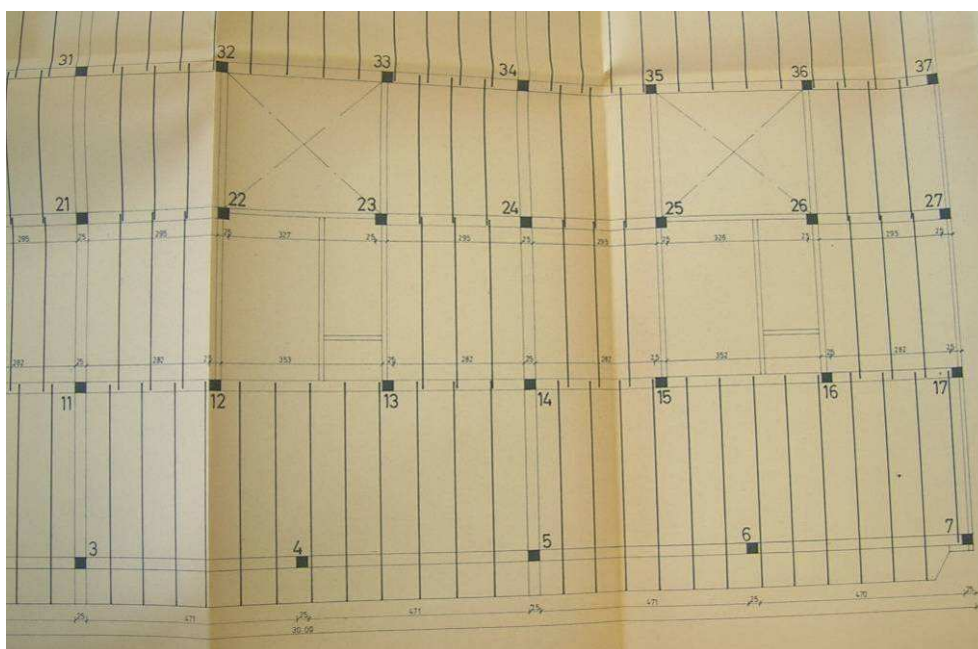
Planta de estructura. Edificio 90C.003, 1966.
